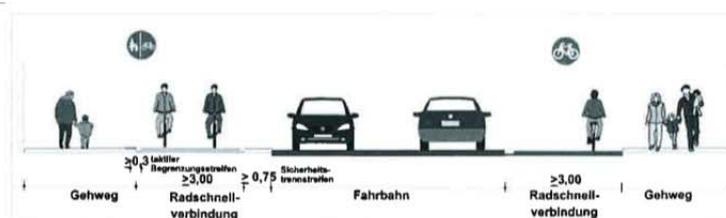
Straßenbegleitende Führung der Radschnellverbindung mit Einrichtungradweg bzw. Radfahrstreifen
